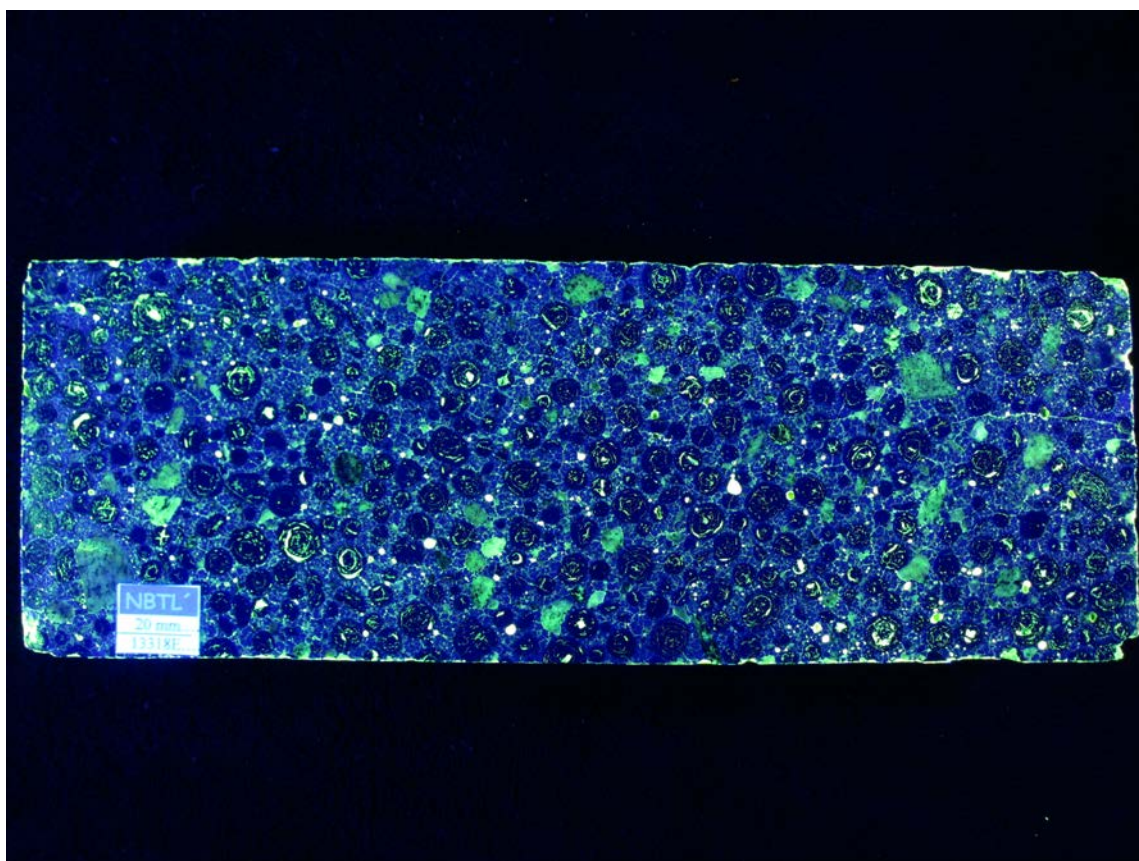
Planslip 13318E i UV-lys. Nordsiden til høyre i bildet
